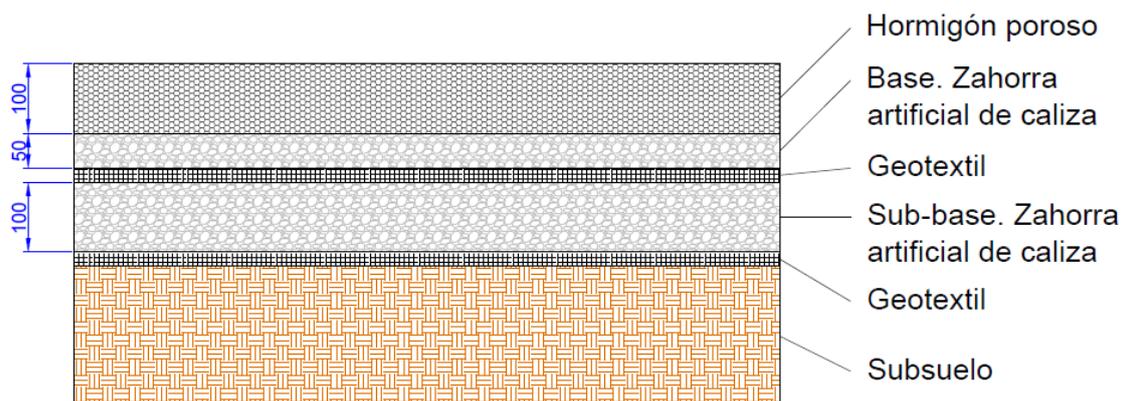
Sección del pavimento permeable utilizado en el carril. (Elaboración propia)
